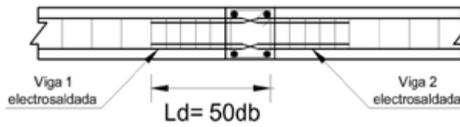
Construcción de la viga de confinamiento ([Brzev, 2008](#))
